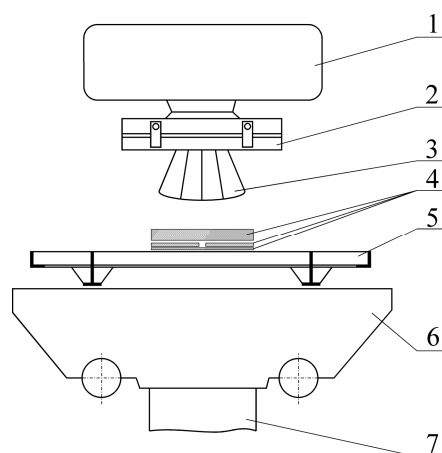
Схема нагружения полунатурного перекрытия: 1– верхняя траверса пресса; 2– система крепления пуансона; 3– пуансон; 4– прокладки; 5– испытуемое перекрытие; 6– тележка; 7– нижняя подвижная траверса
